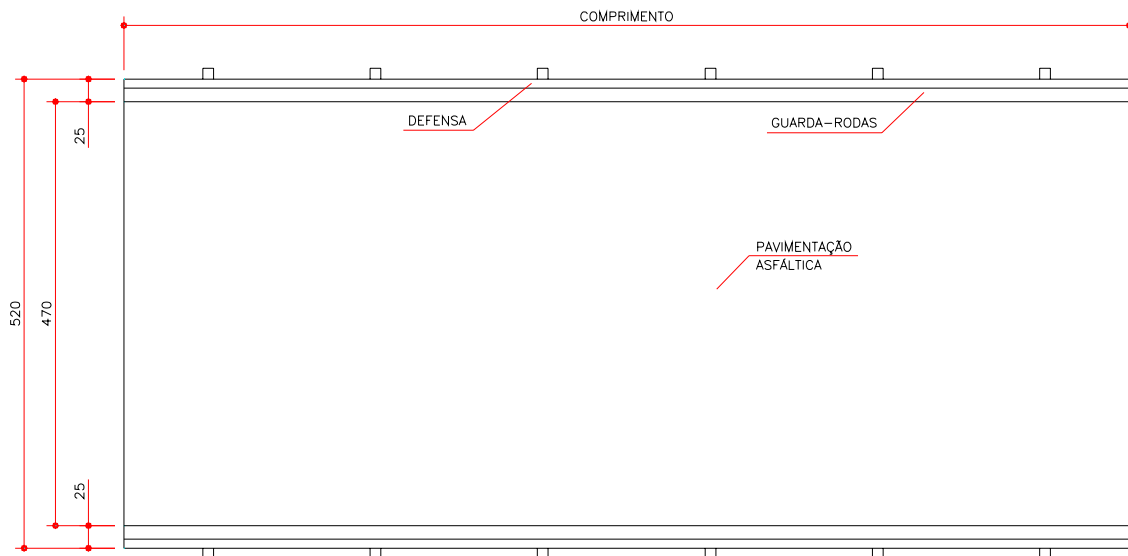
Vista superior da ponte em placa protendida transversalmente
